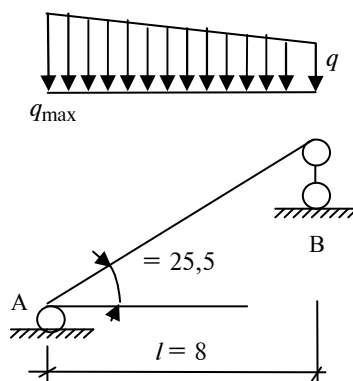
Расчётная схема плиты при расчёте на монтажные нагрузки
